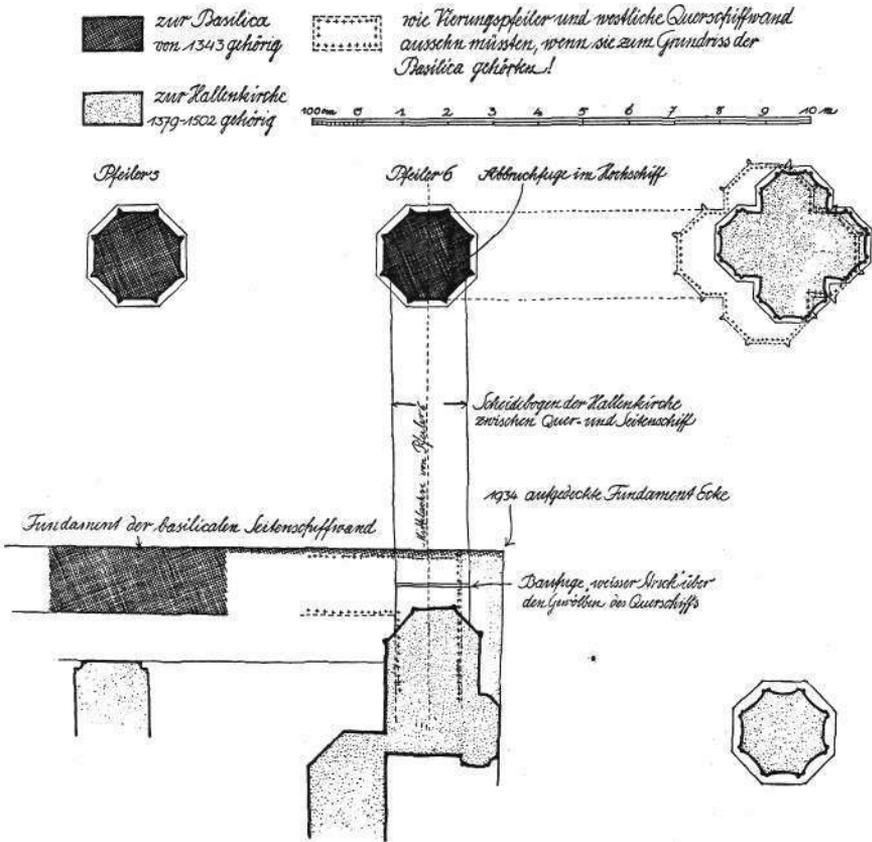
Grundriß am Zusammenschluß von Basilika und Hallenchor
